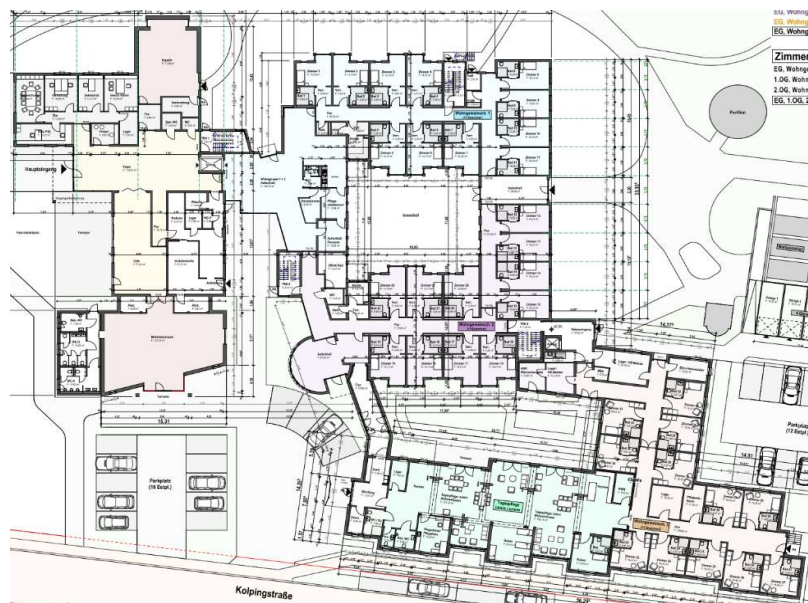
Grundriss des Erdgeschosses der Einrichtung St. Elisabeth-Stift Neuenkirchen, Quelle: St. Elisabeth-Stift Neuenkirchen.
